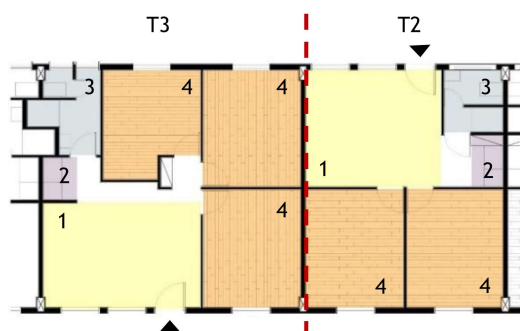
Planta de tipologias existente. Legenda: 1-Sala comum, 2-Cozinha, 3-Instalação sanitária, 4-Quarto.
